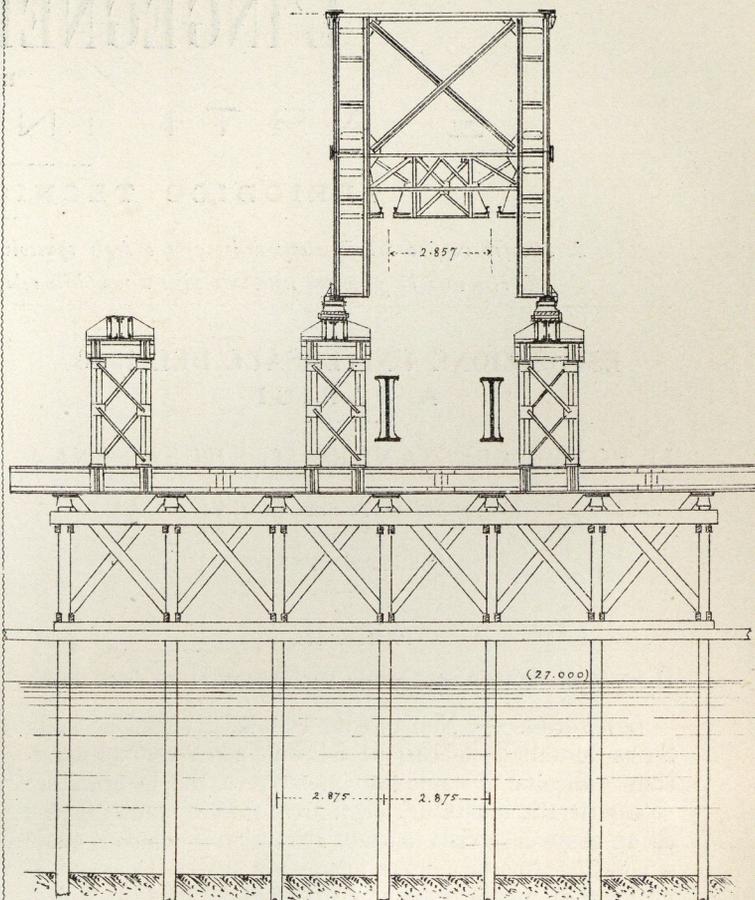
Sezione trasversale della travata su di una delle due stilate d'appoggio provvisorio.
